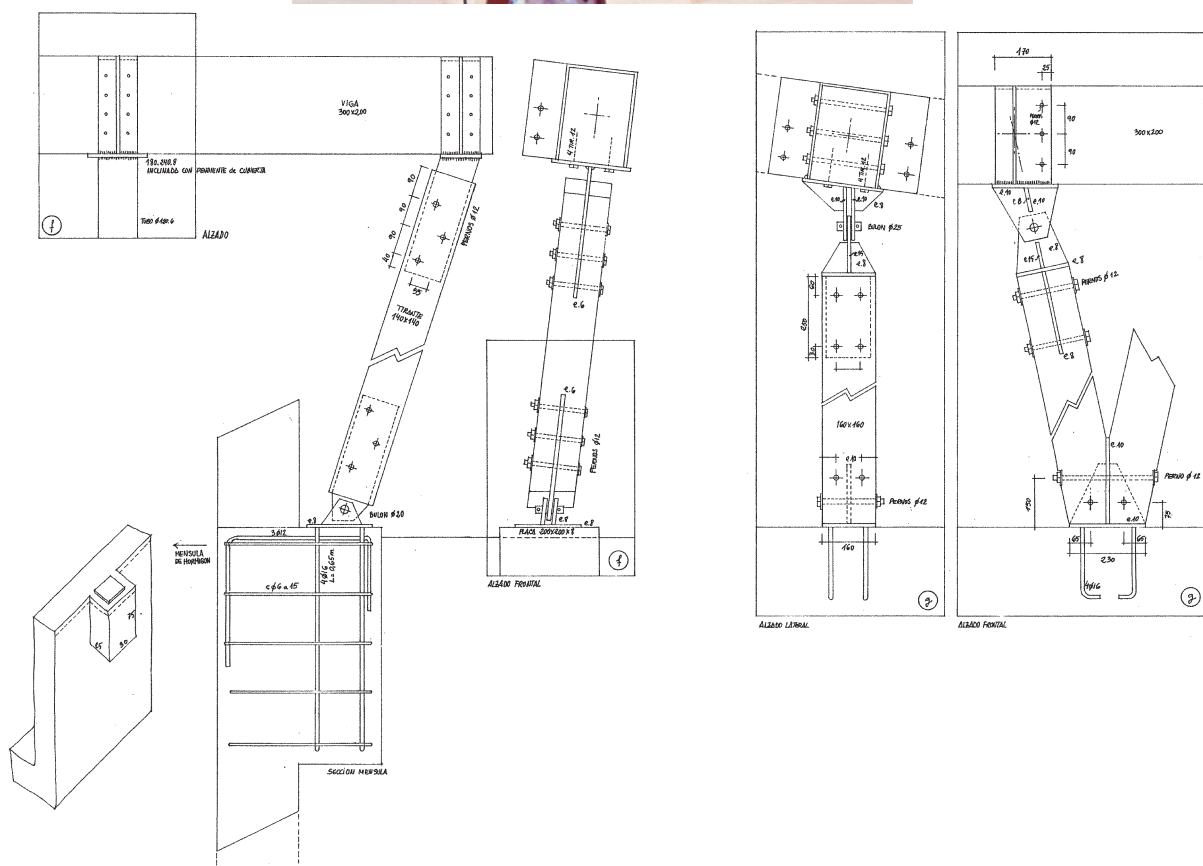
y 5b. Piezas en “T” metálicas para unión de vigas y viguetas.
